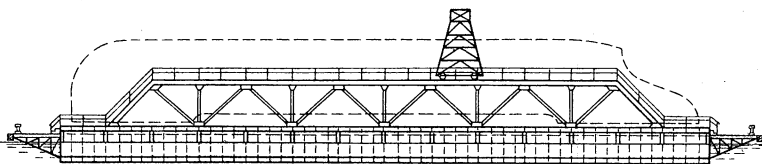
Betonschiff, kieloben, im Bau auf der Bühne.
